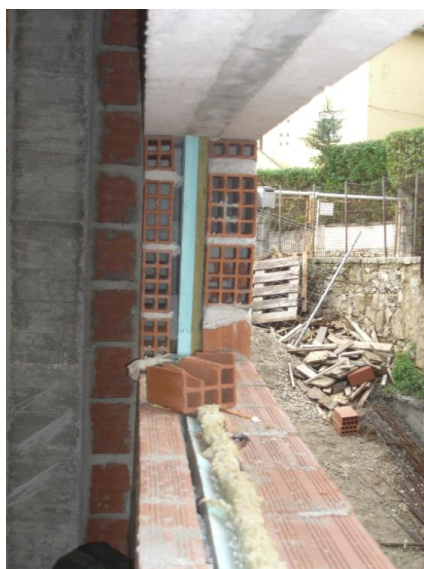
i - Vista sobre uma zona de ligação de parede exterior com caixilharia
